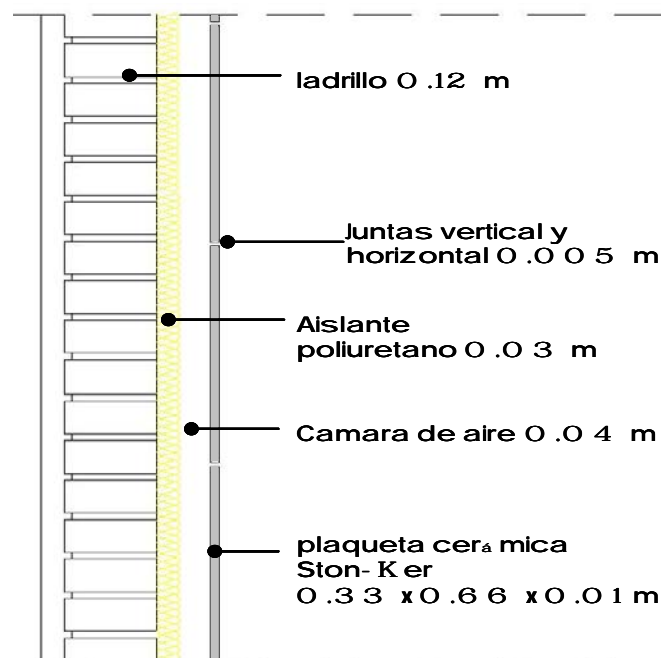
Fachada ventilada de juntas abiertas Ston-ker, Porcelanosa. (Imagen del autor)
